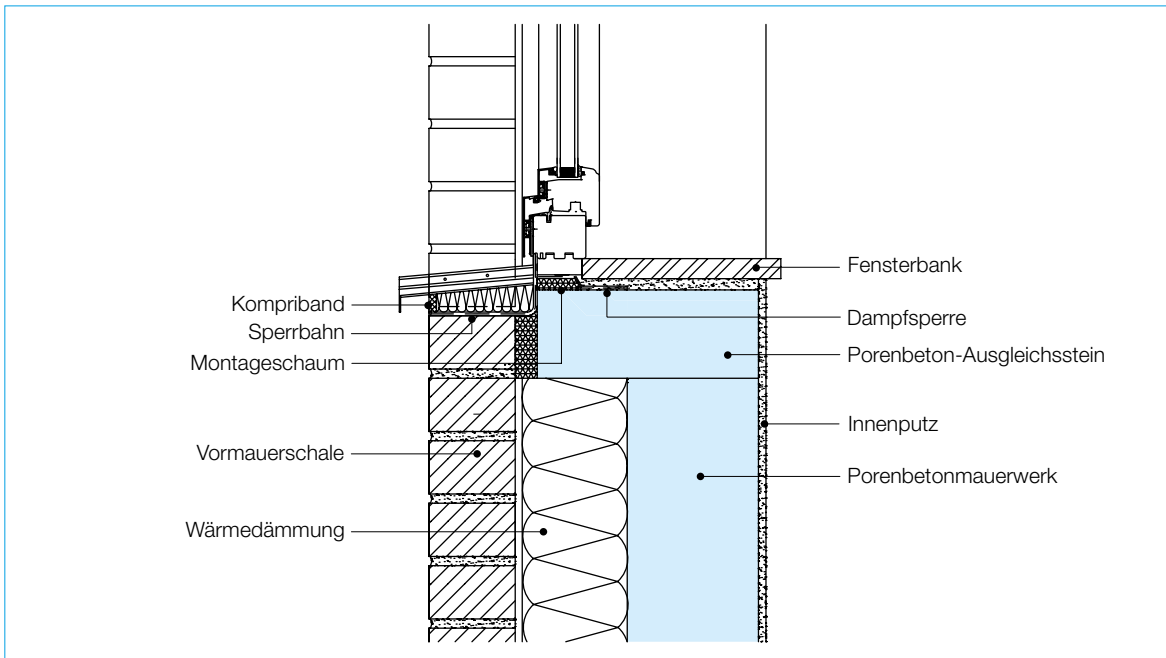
Ausbildung der Brüstung bei einer zweischaligen Außenwand aus Porenbetonmauerwerk mit Wärmedämmung und Vormauerschale
